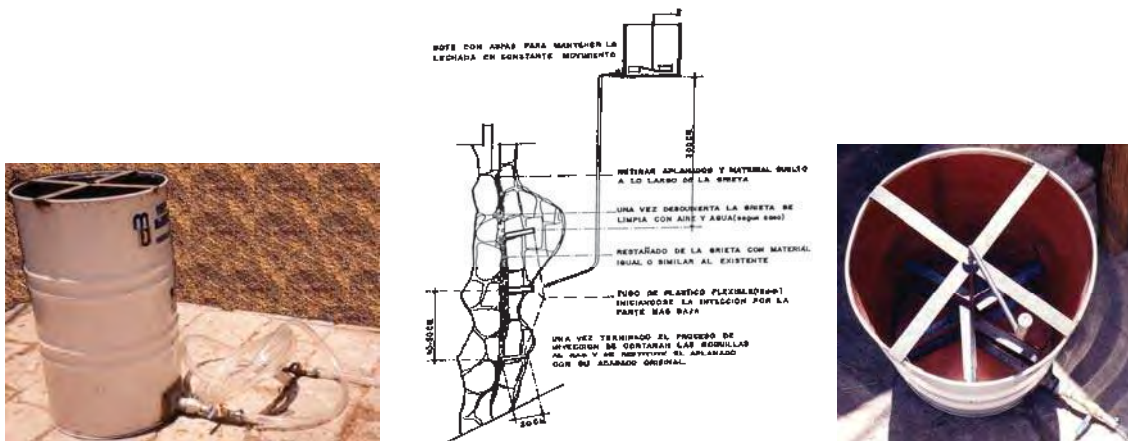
Técnica para la inyección por gravedad en grietas
